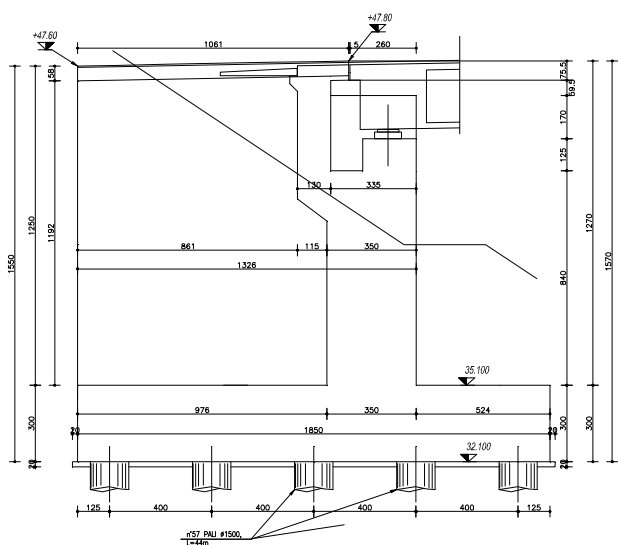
Sezione longitudinale Spalla lato Parma – Progetto Definitivo
